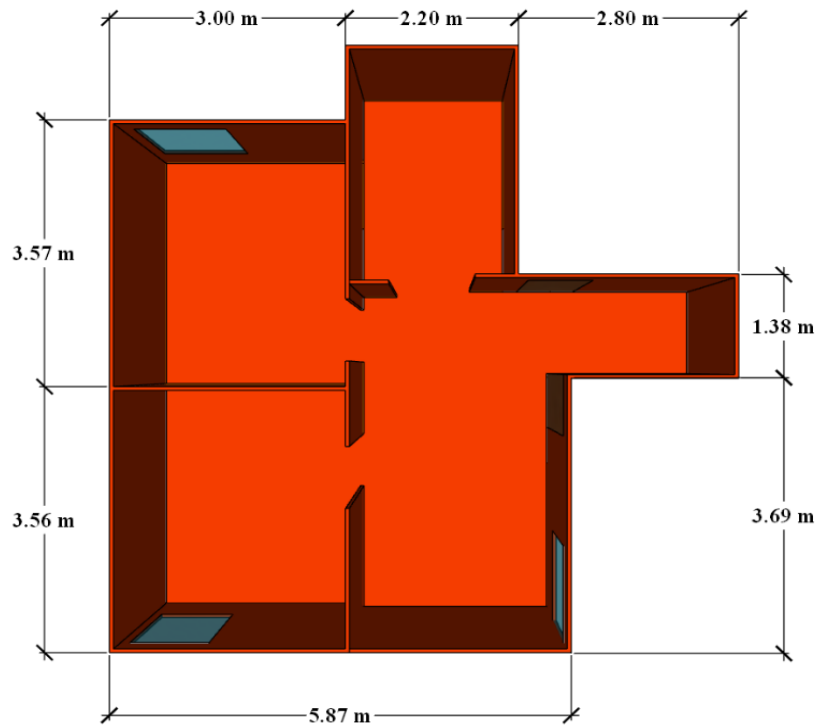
Dimensiones de las zonas térmicas de la planta baja
